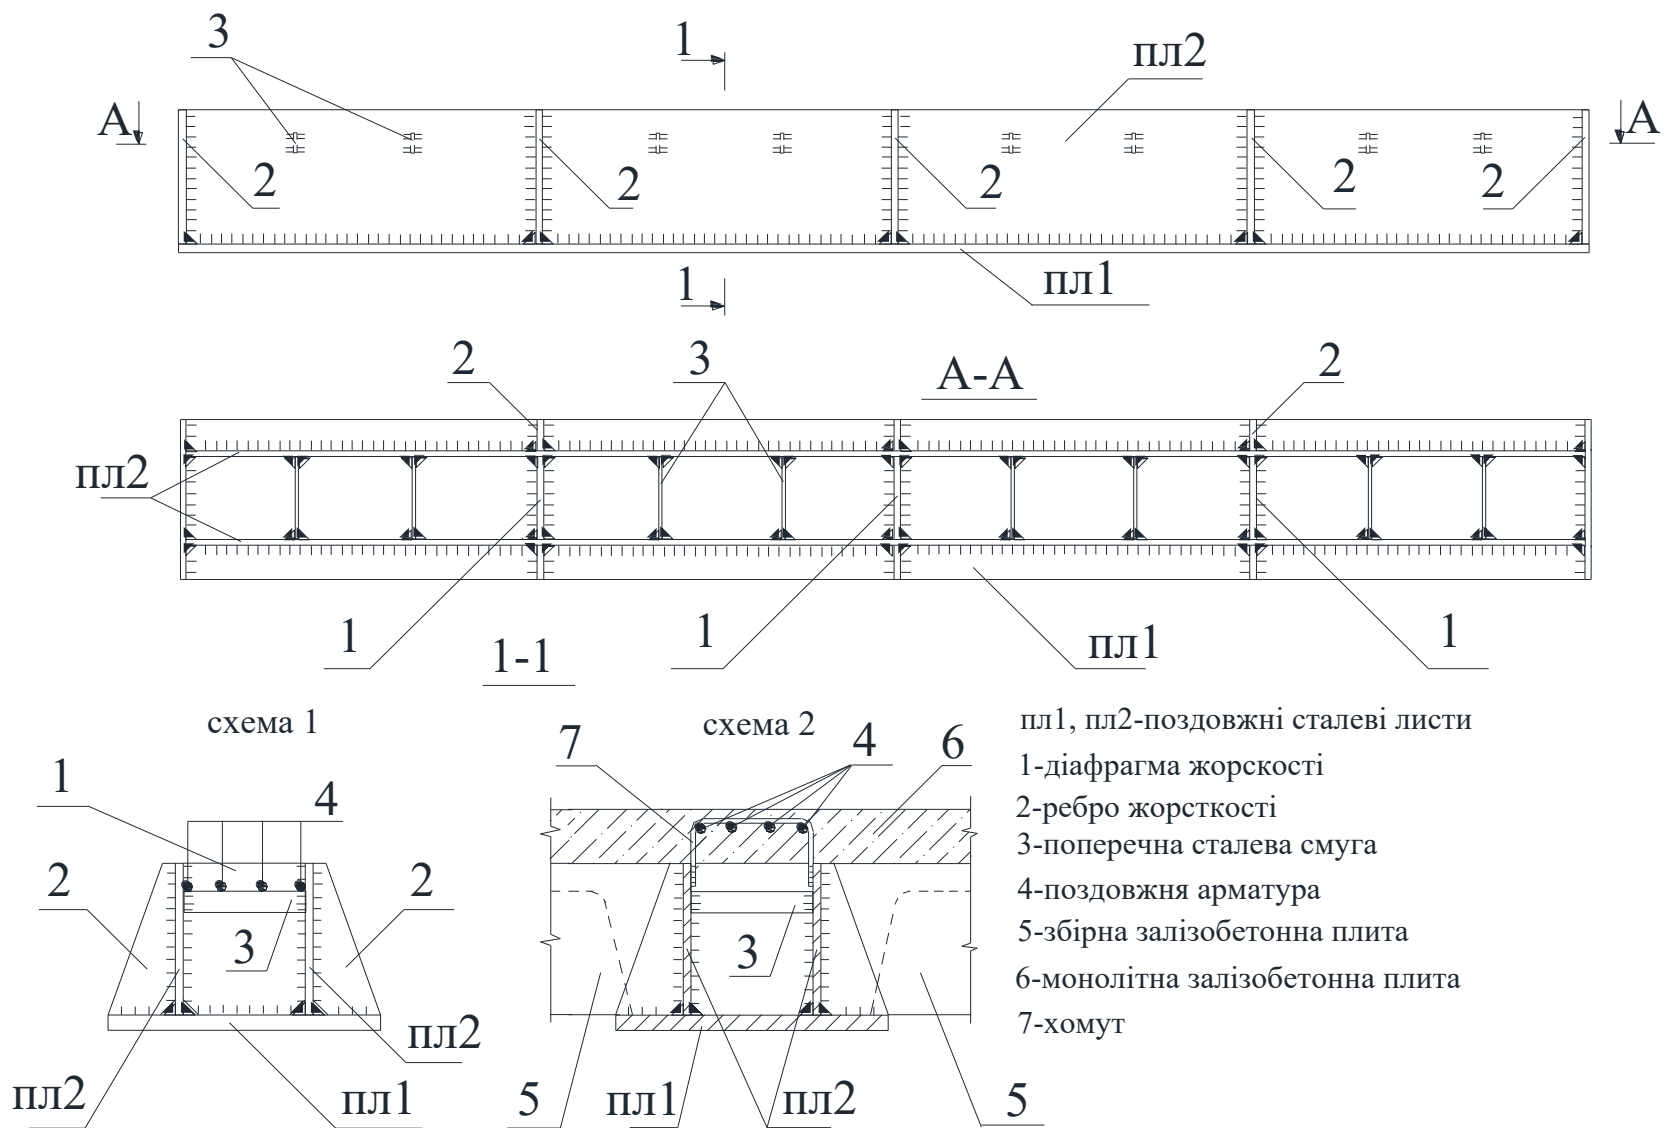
Збірний сталезалізобетонний ригель перекриття
